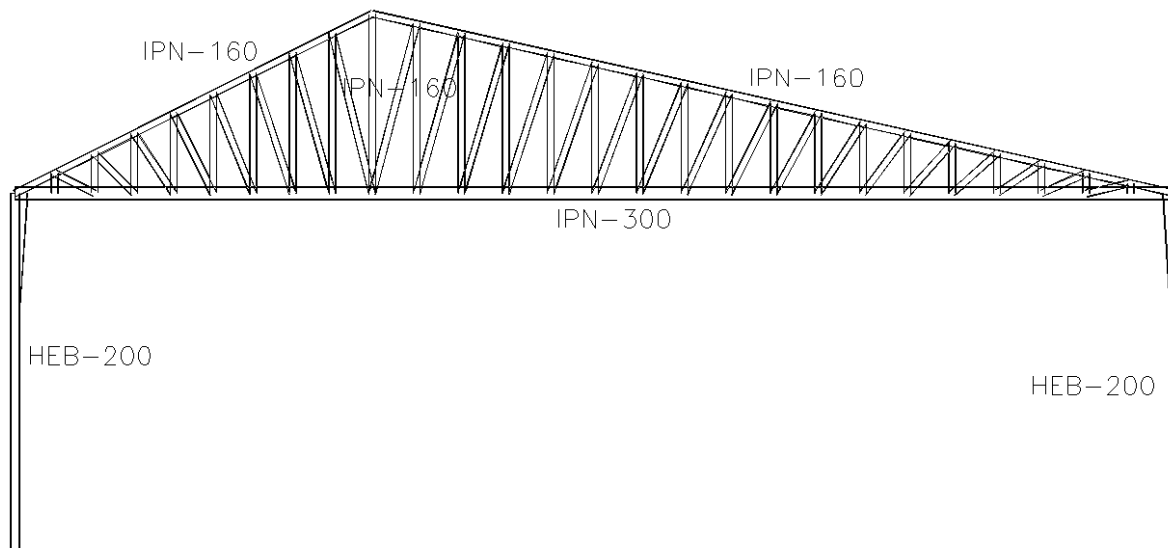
Pórtico tipo con dimensión de los perfiles
